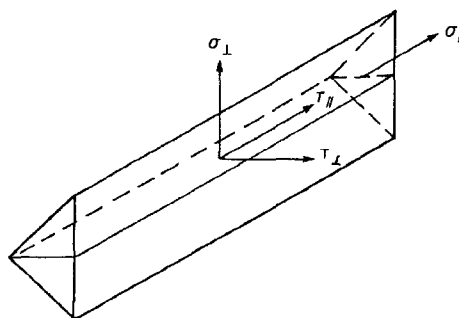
Spannungen im wirksamen Kehlnahtquerschnitt
